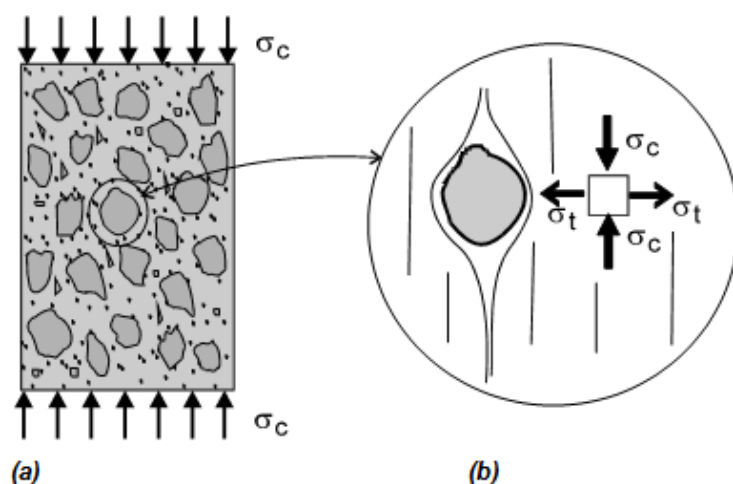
(a) Elemento de concreto comprimido, (b) Prováveis fissuras ao redor dos agregados para tensões de compressão
